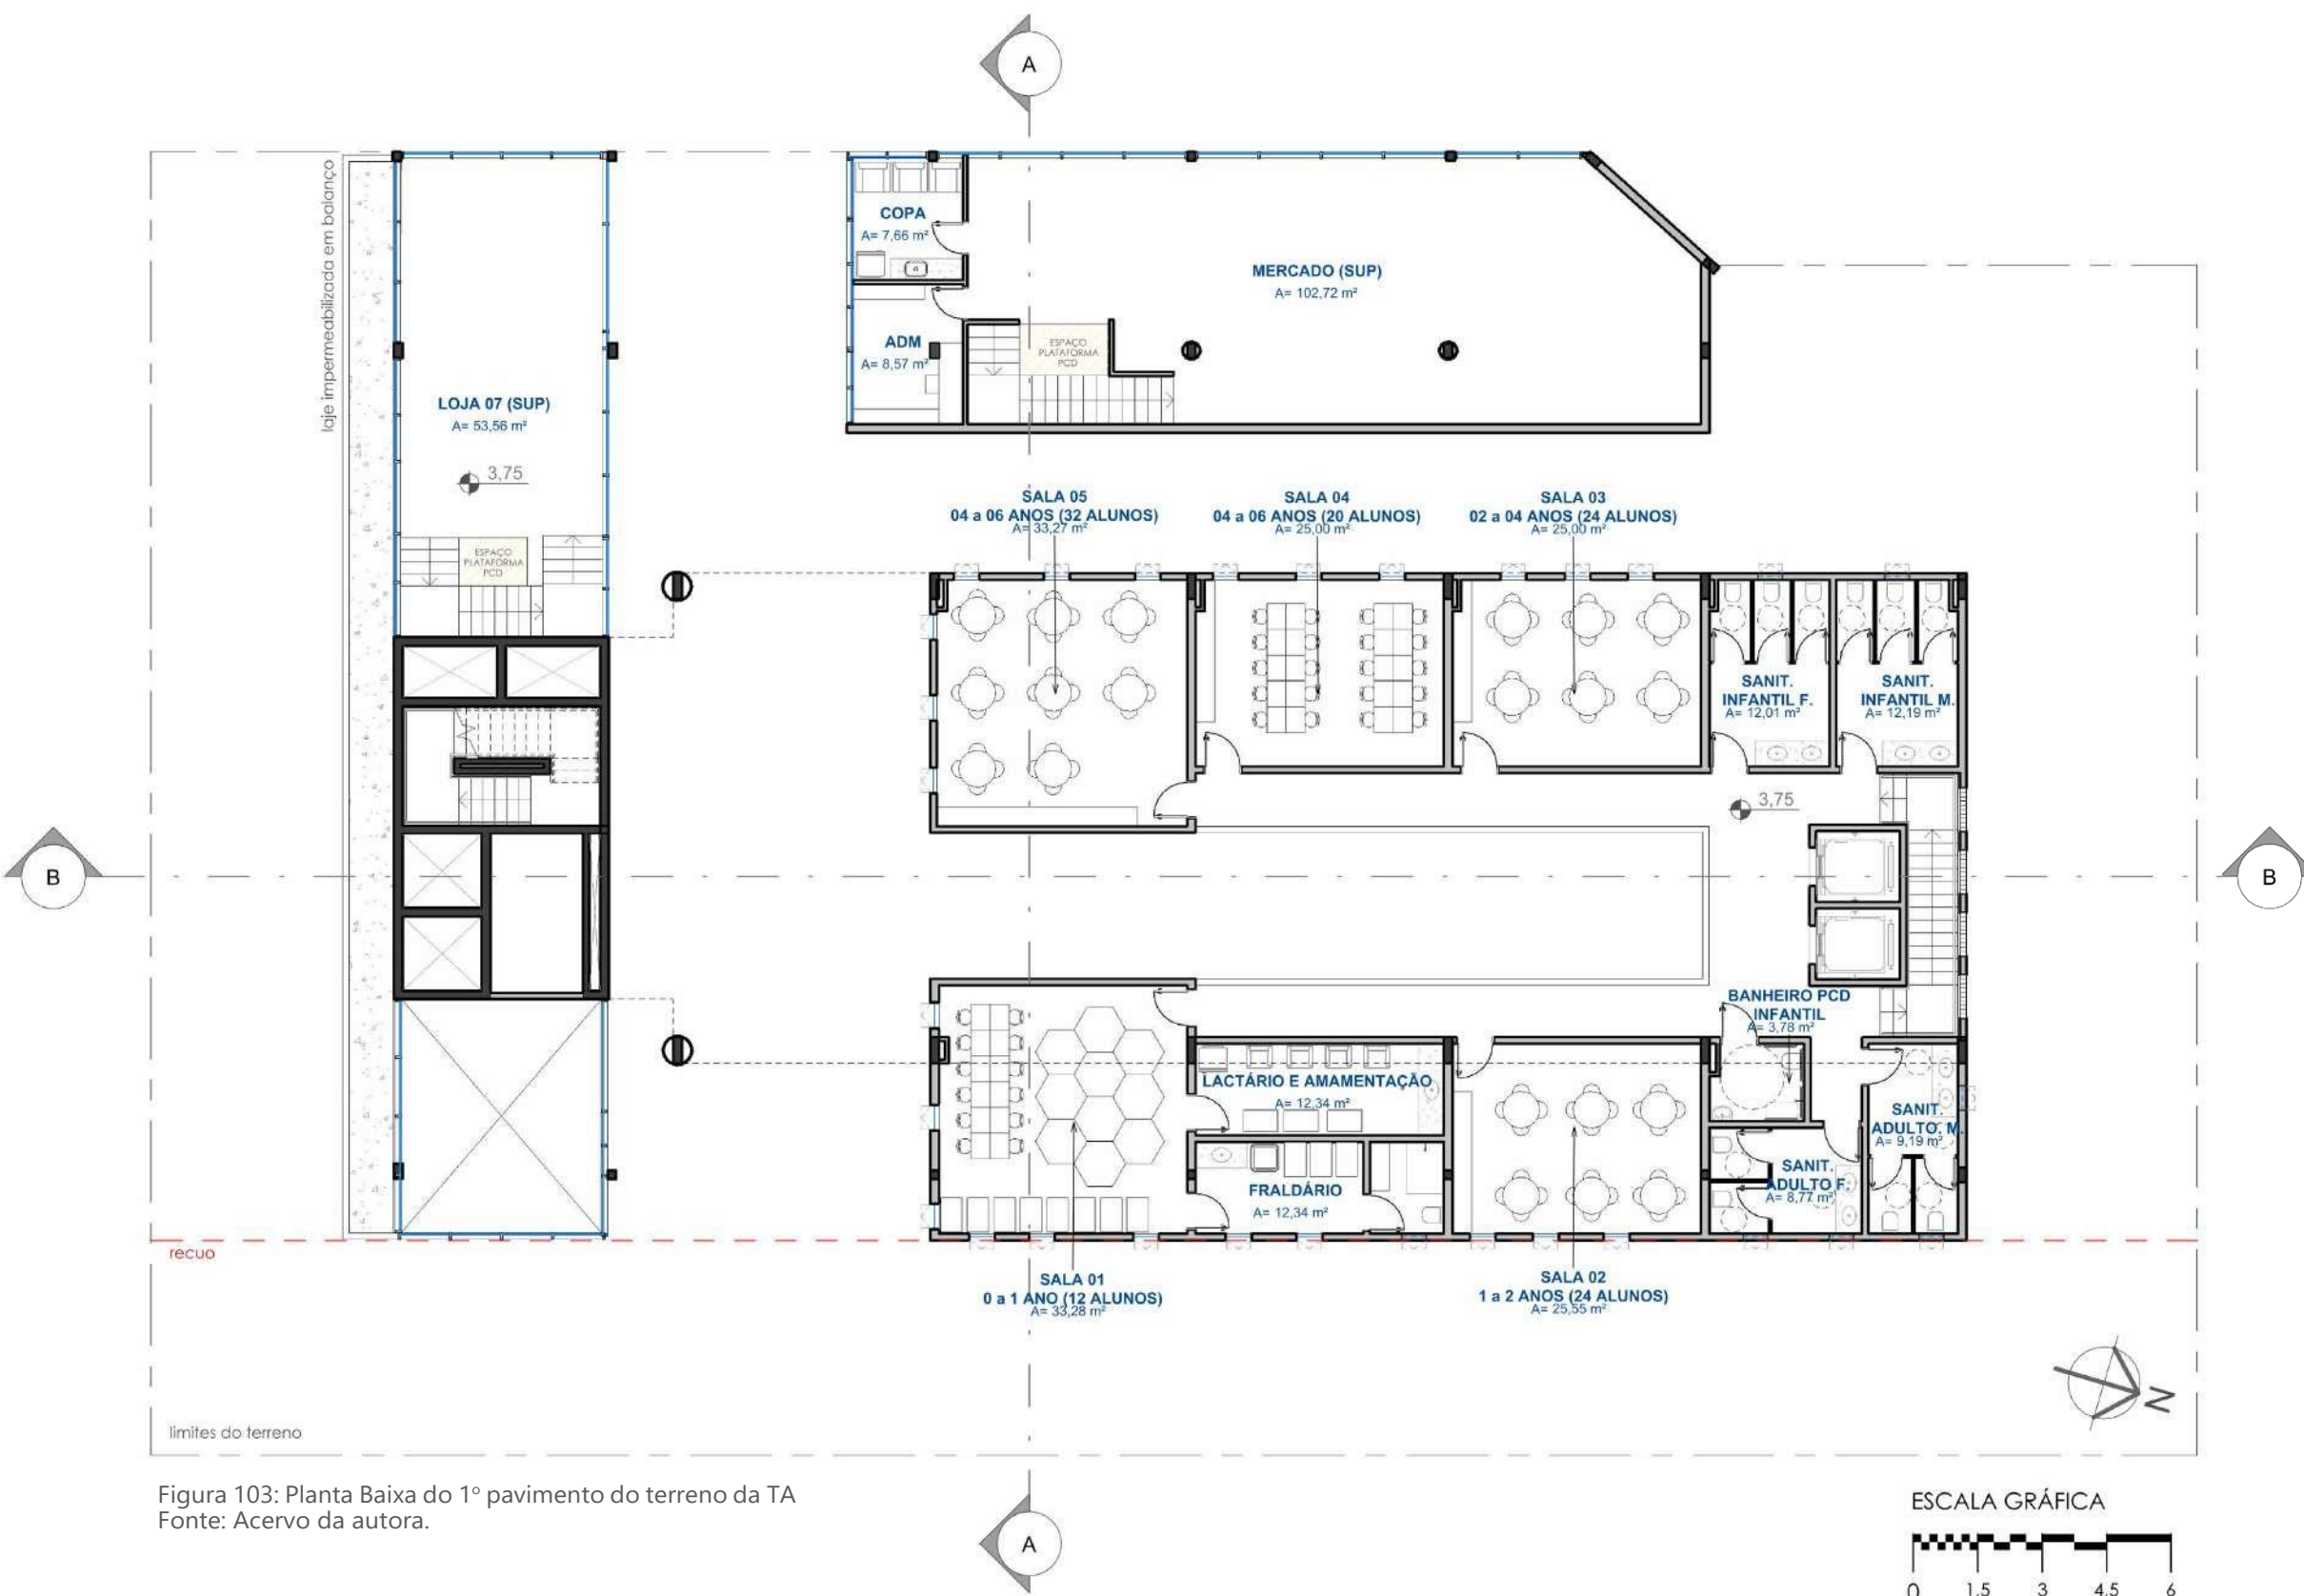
Planta Baixa do 1º pavimento do terreno da TA
